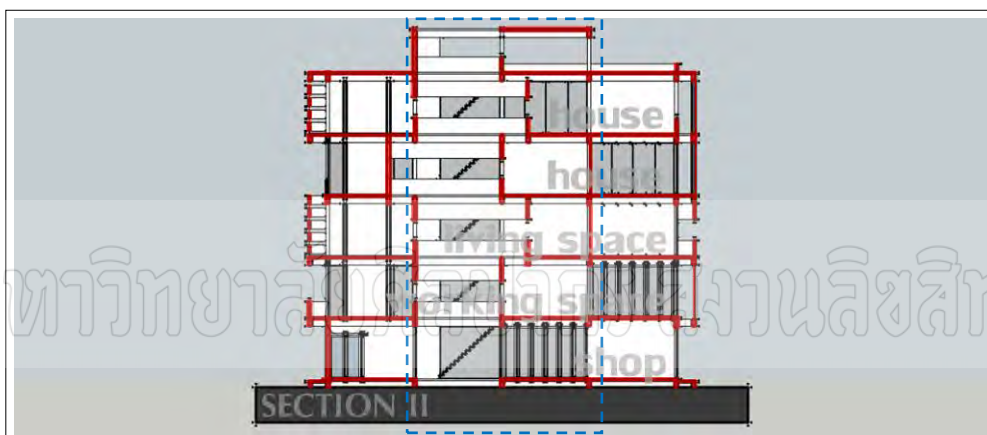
รูปด้านตึกแถว A (Develop elevation type A)
